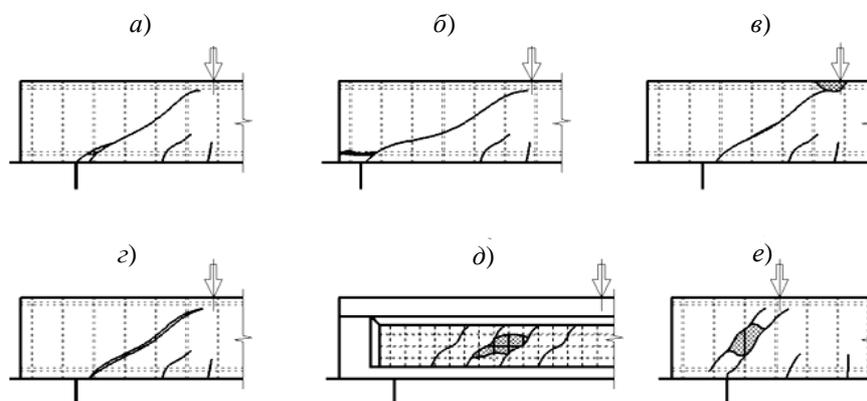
Характерные виды разрушения железобетонных элементов в зоне среза
